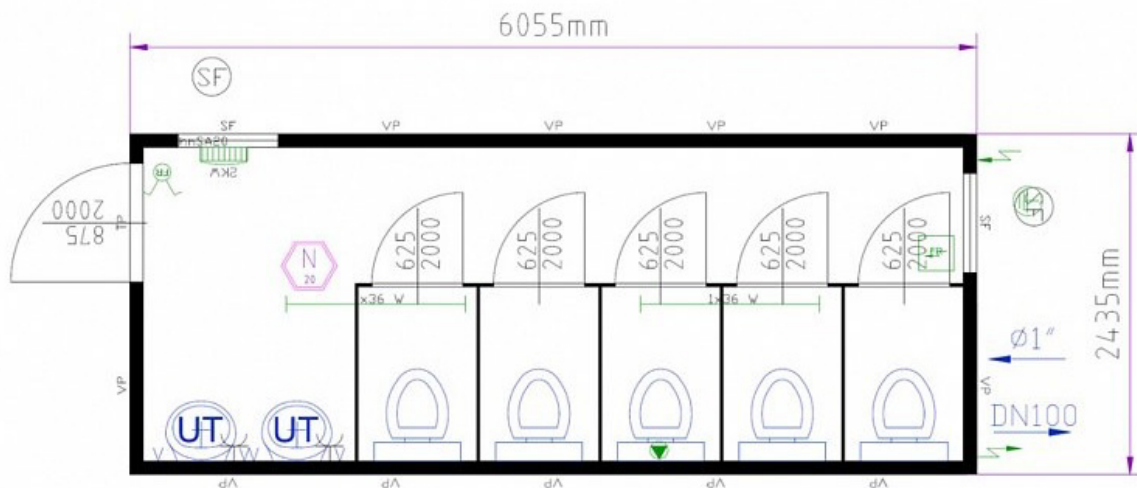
Buňka sanitární pro muže – půdorysné schéma
